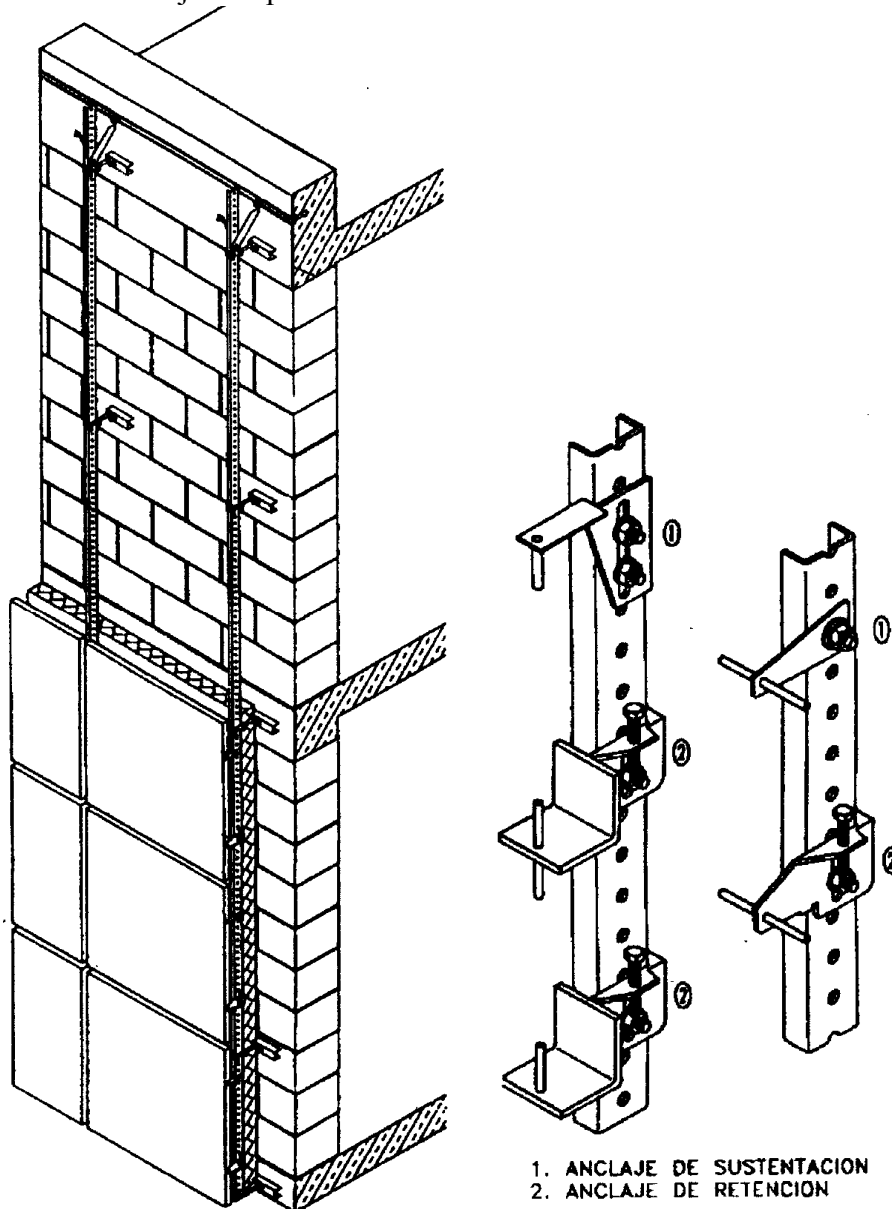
Anclajes mediante subestructuras de raíles metálicos.
